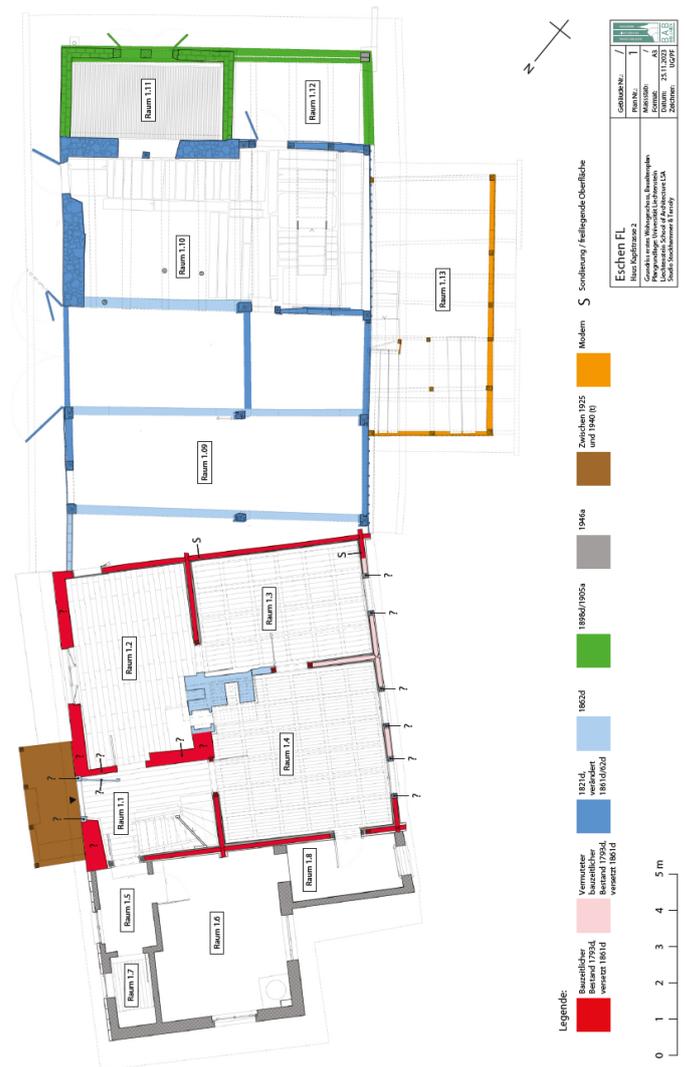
Grundriss erstes Wohngeschoss, Baualtersplan.
